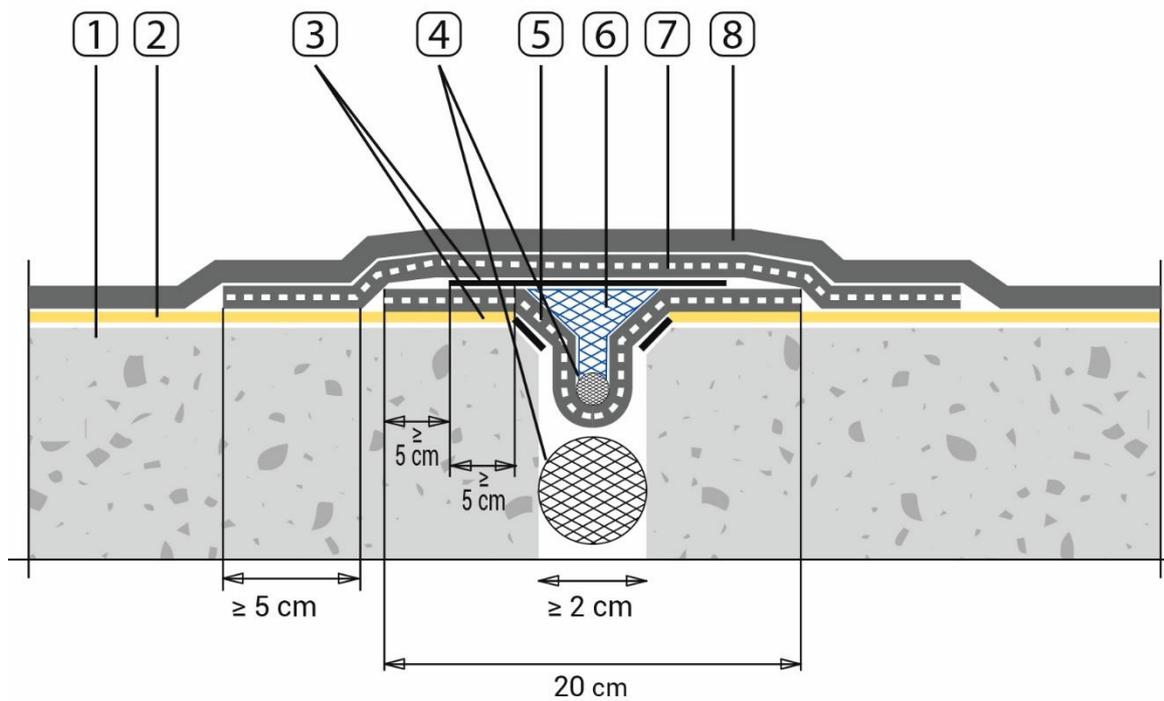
Exemple de traitement d'un joint de dilatation en joint plat (suite)
